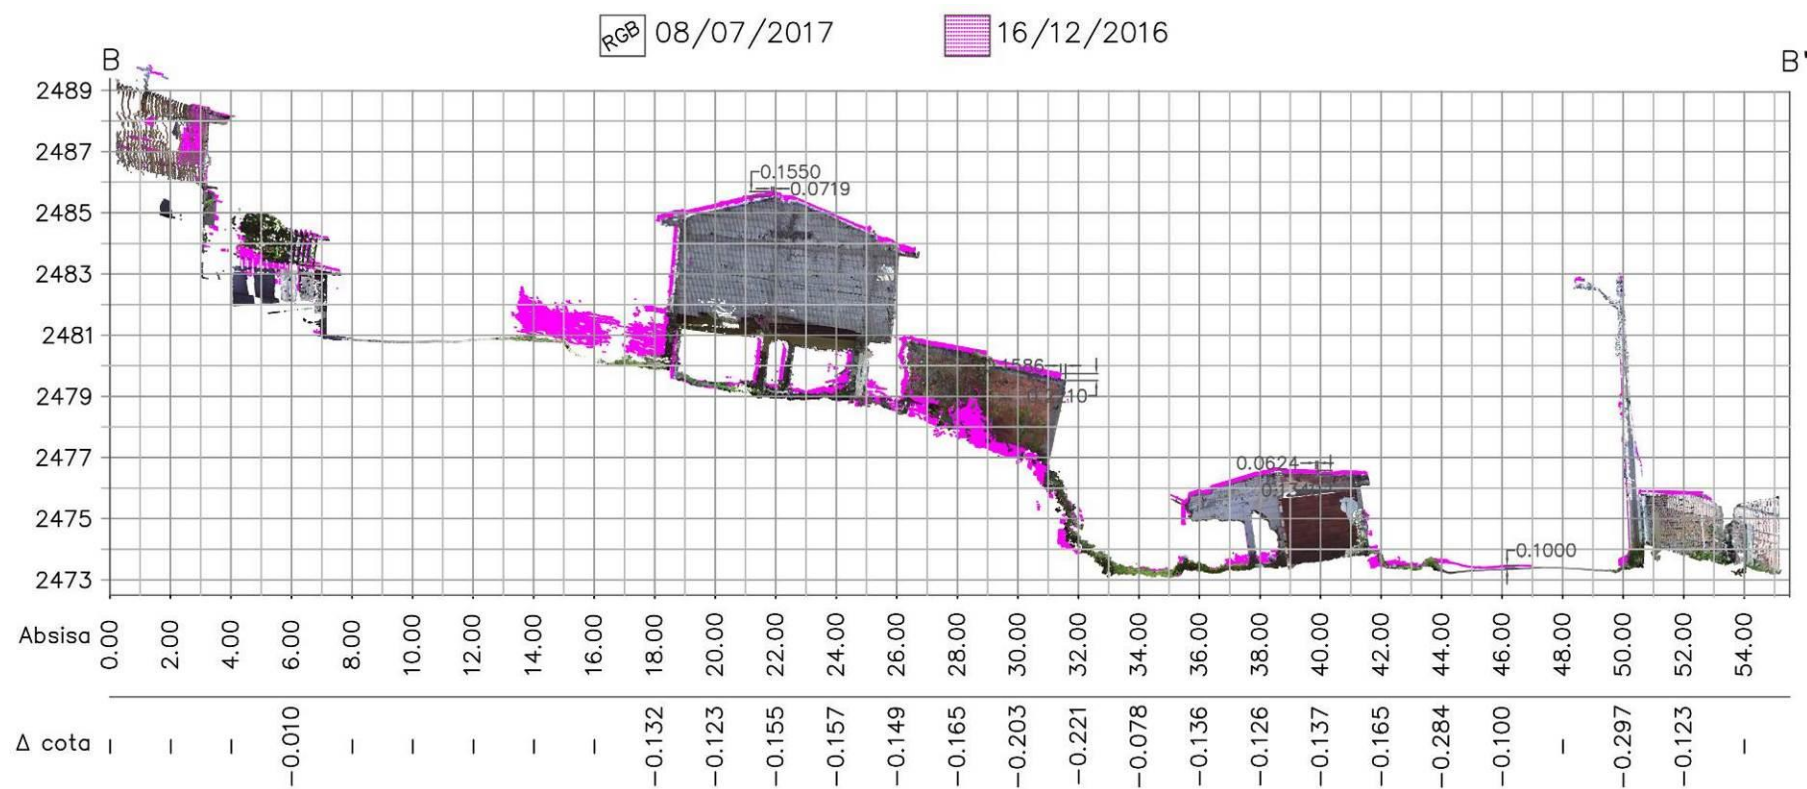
Levantamiento 1 vs levantamiento 3, perfil B-B' en metros.
